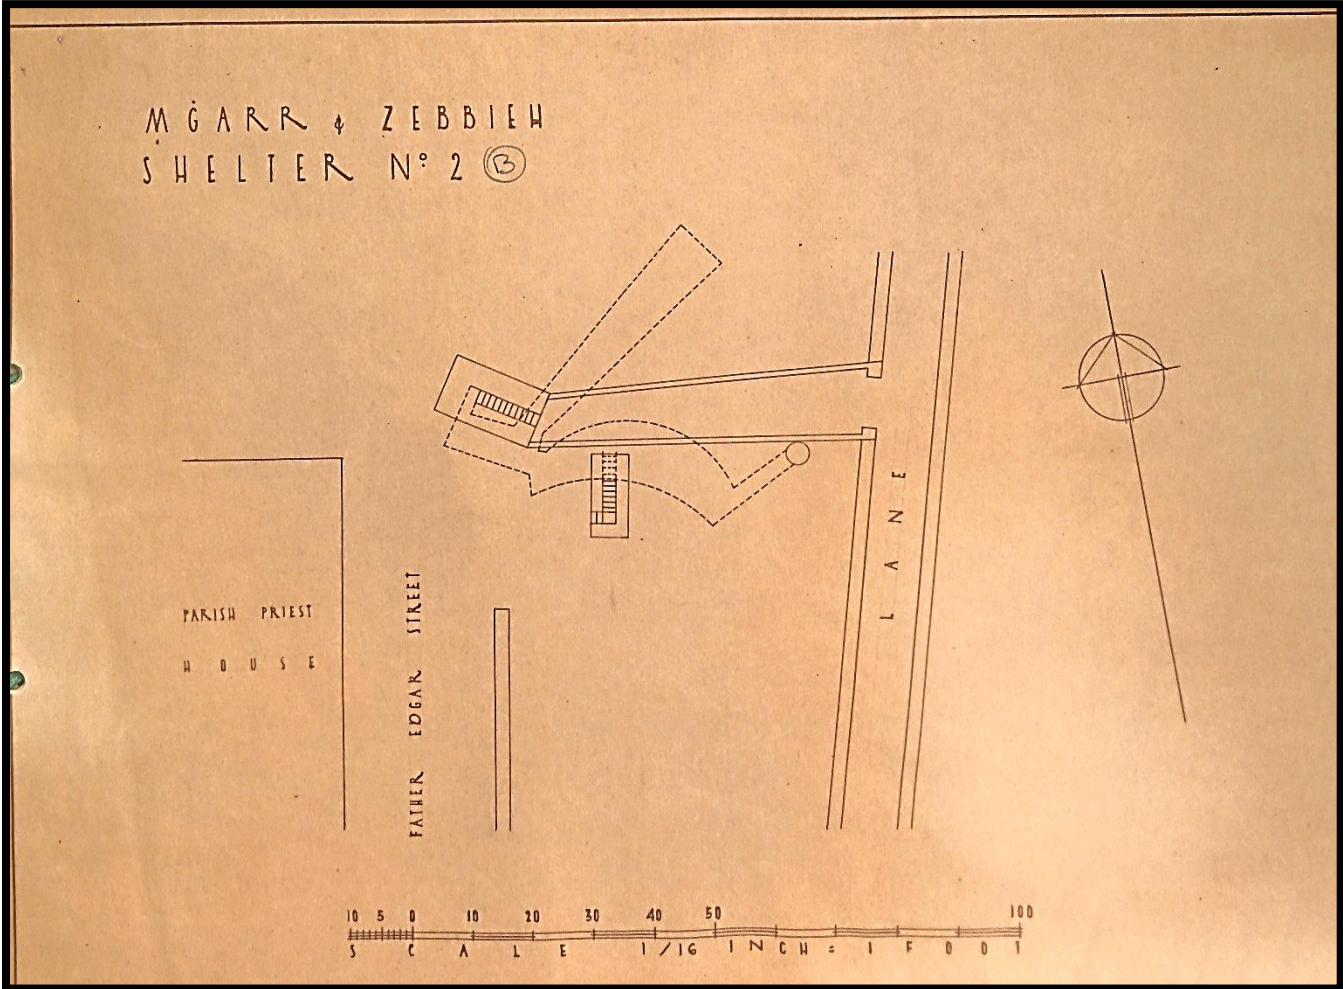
Planta do Abrigo nº2B "Father Edgar Street (Parish Priest House) – Lane"
